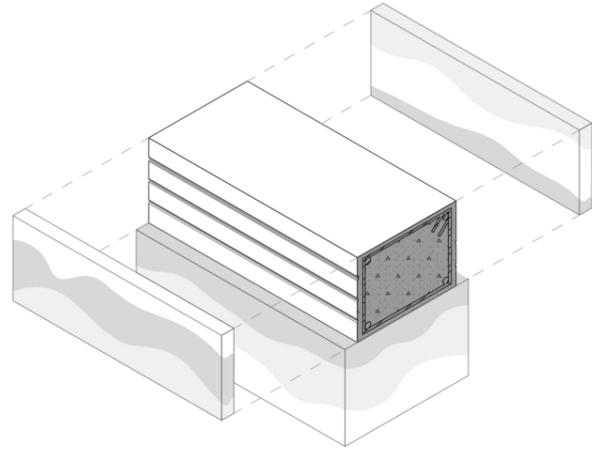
Detalle cadena de hormigón. Fuente: Elaboración propia
